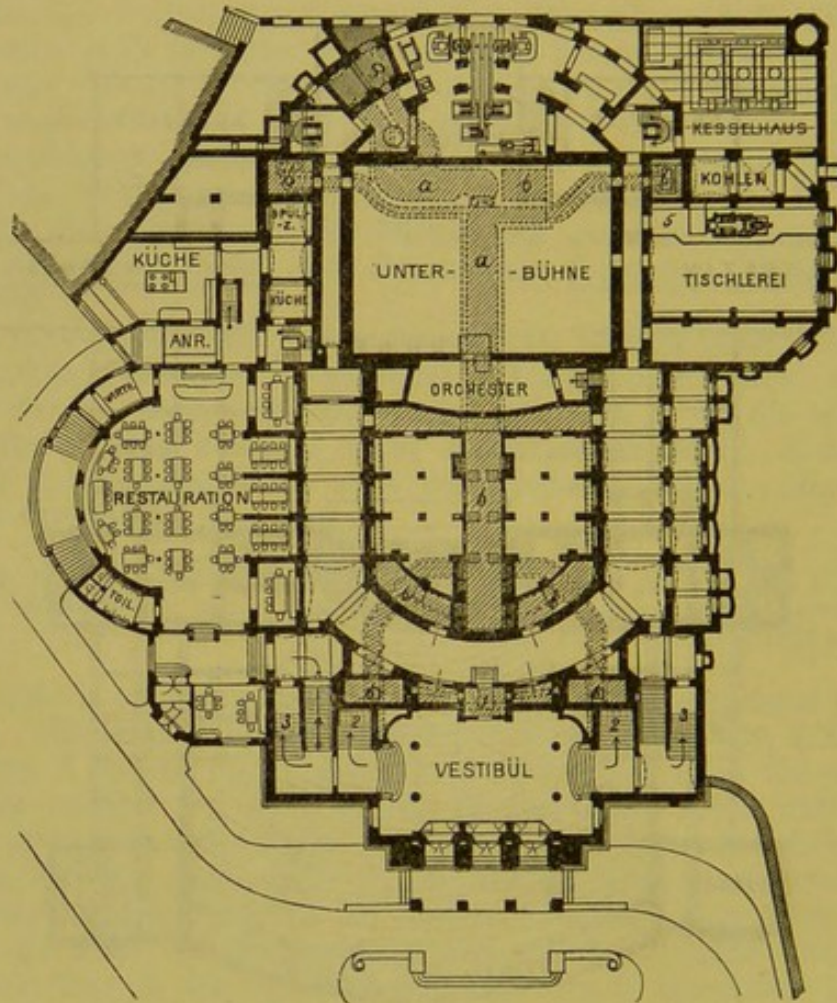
Untergeschoss des Stadttheaters in Halle.
